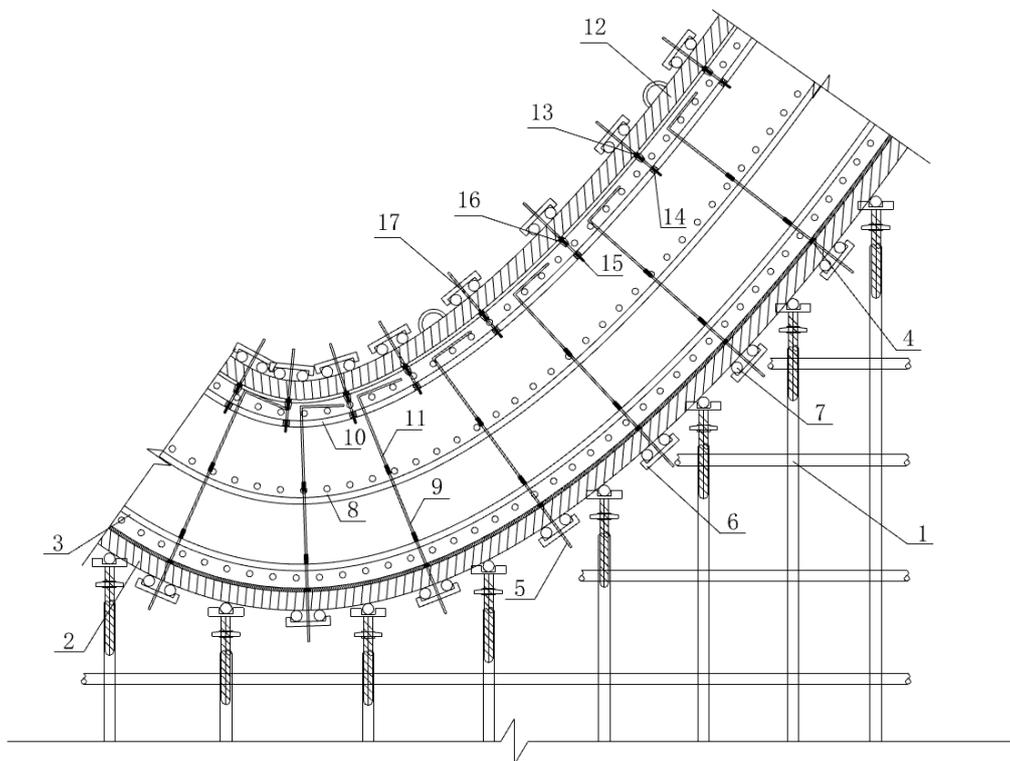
曲面混凝土厚壳对拉螺杆示意图
